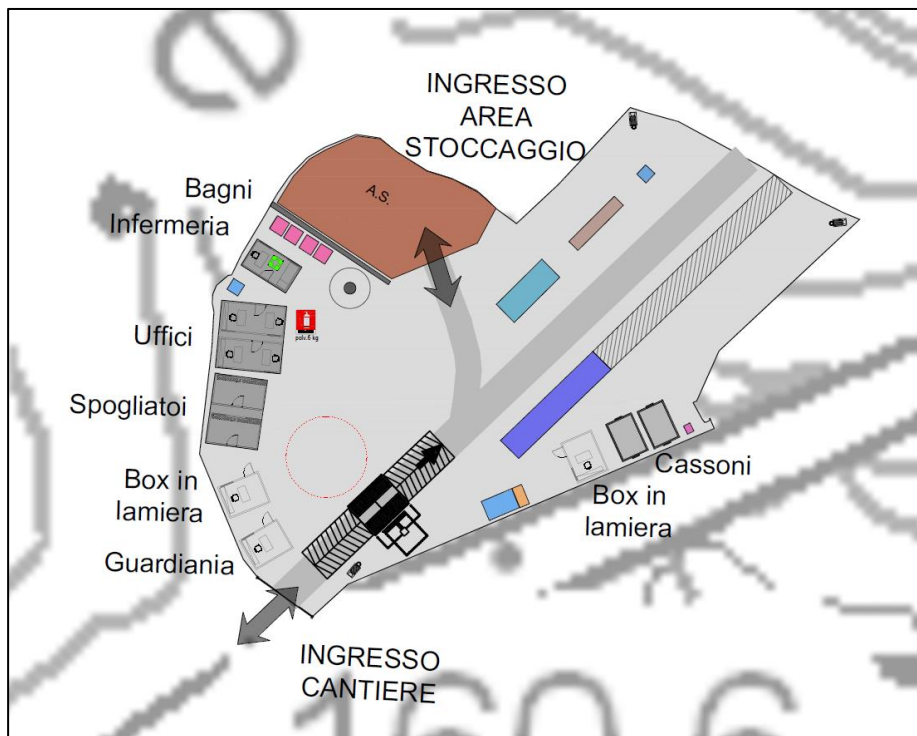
Layout cantiere operativo all'imbocco sud (CO 01)
